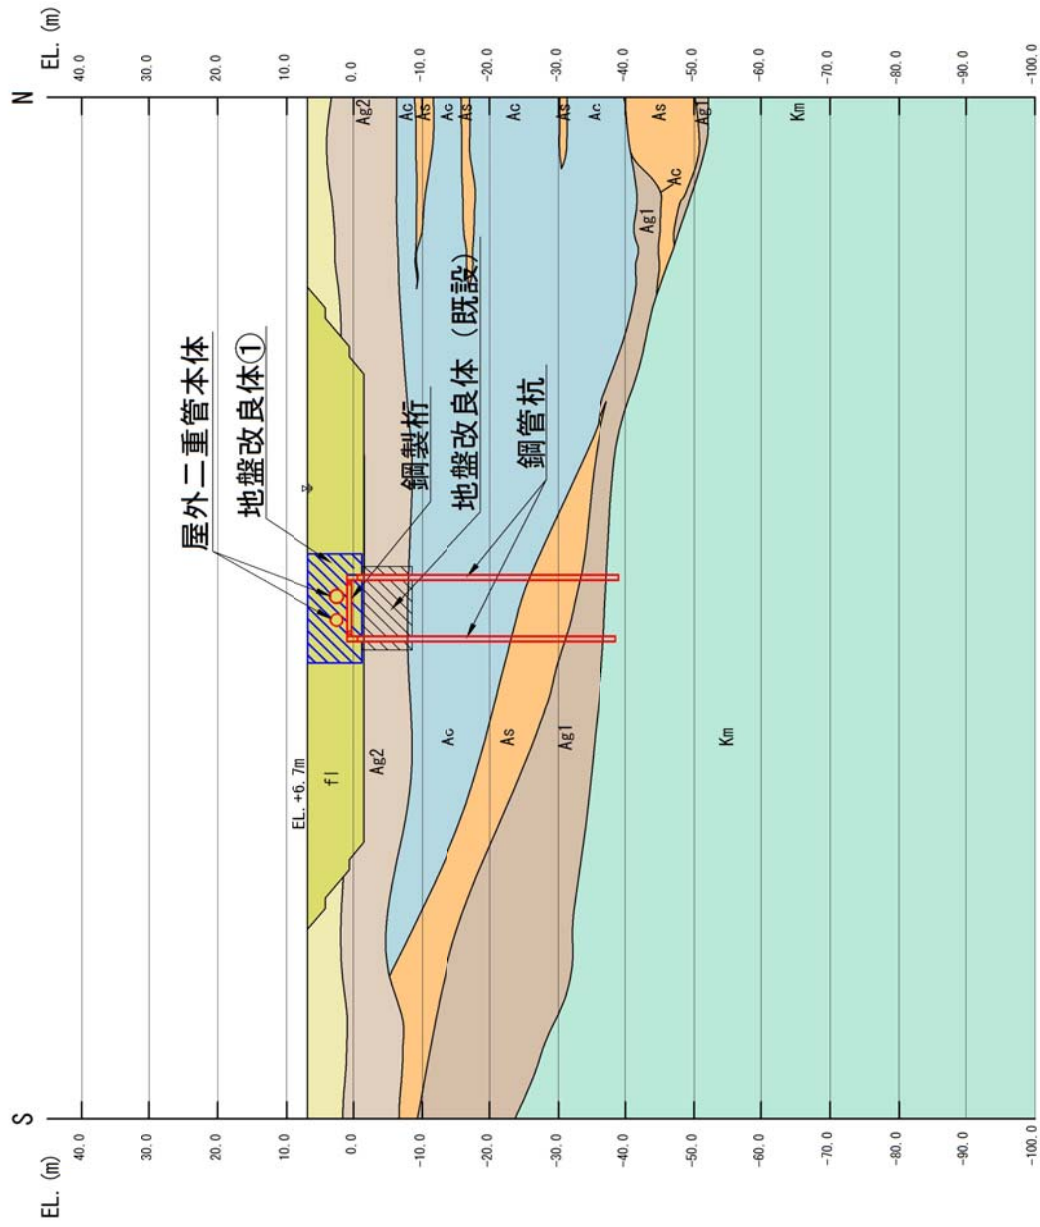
(2) 屋外二重管基礎の評価対象断面図 (B-B 断面)
